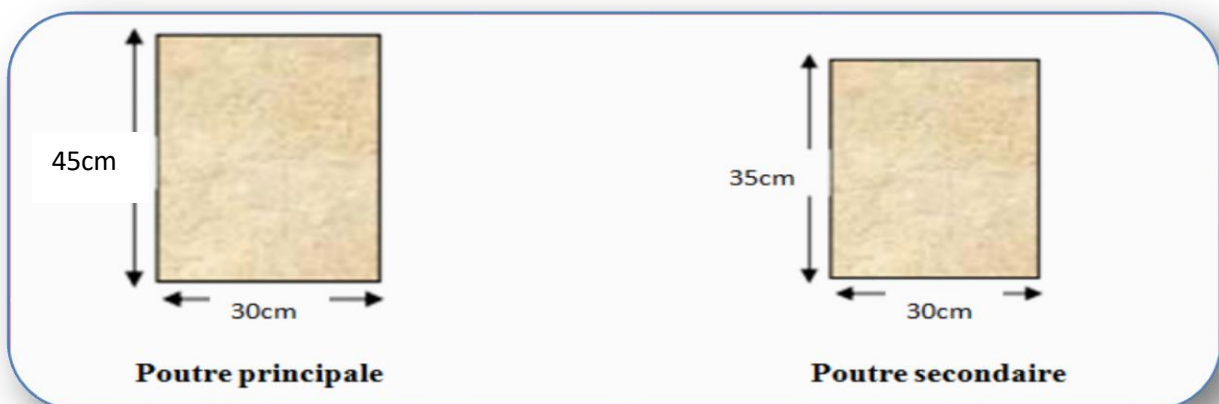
pré dimensionnement des poutres (Principales et Secondaires)
